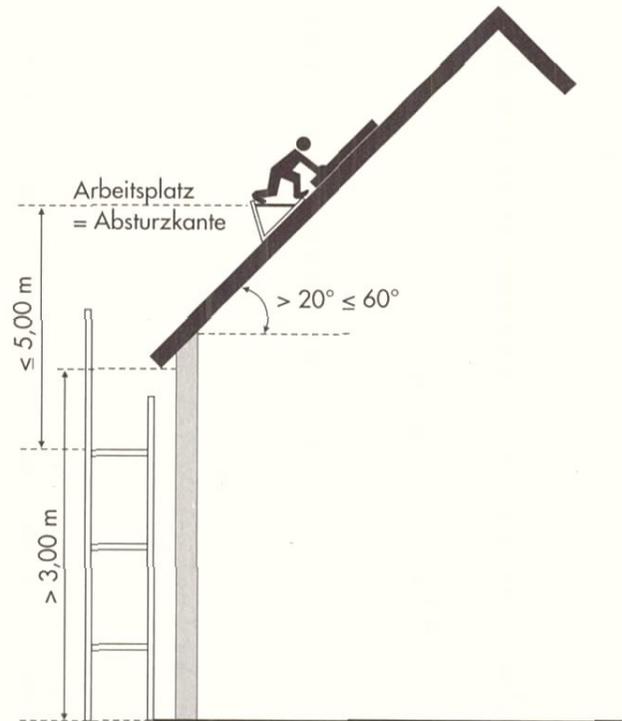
Dachfanggerüste für Arbeiten auf geneigten Dachflächen.
